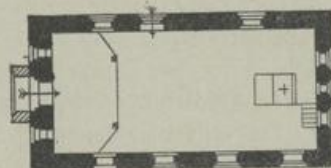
Drense. Grundriß der Kirche. (Nach einer älteren Zeichnung beim Staatlichen Hochbauamt in Prenzlau.)
